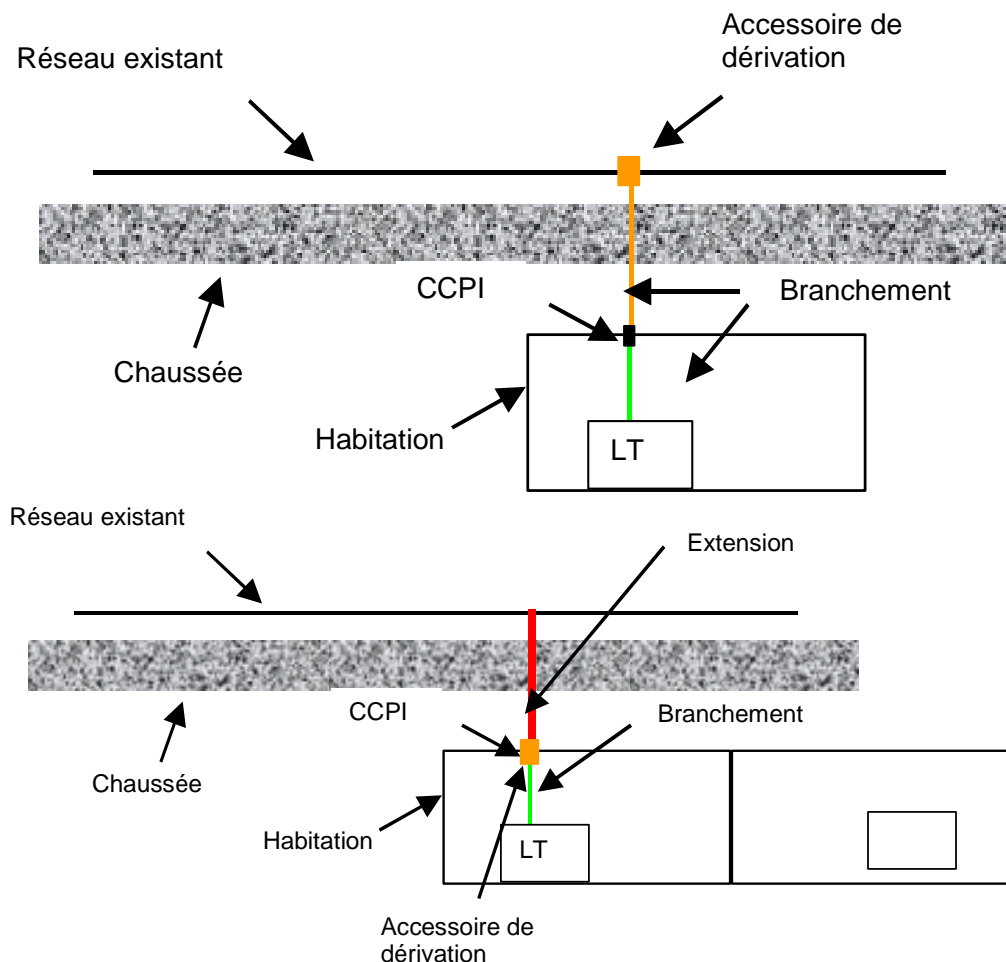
Raccordement individuel BT > 36 kVA avec traversée de chaussée
